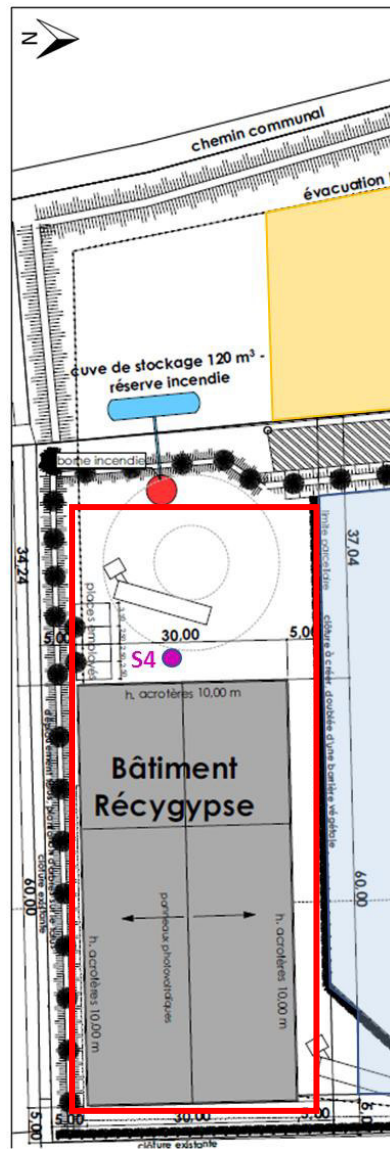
Plan de localisation du sondage prélevé sur site par Antea Group en Mai 2017
